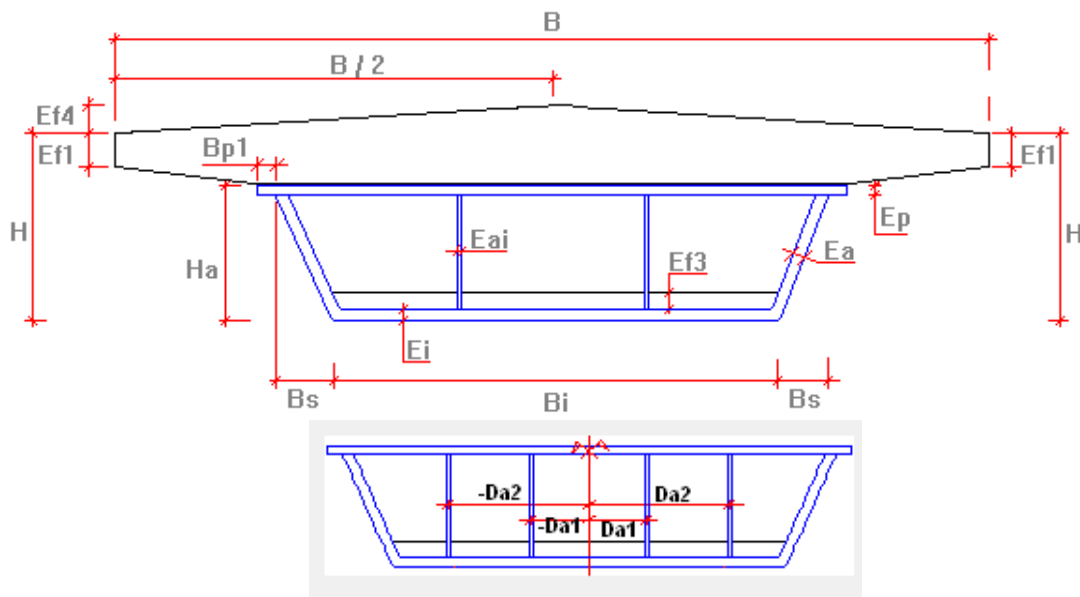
Sección transversal del puente (cajón multicelular cerrado).
